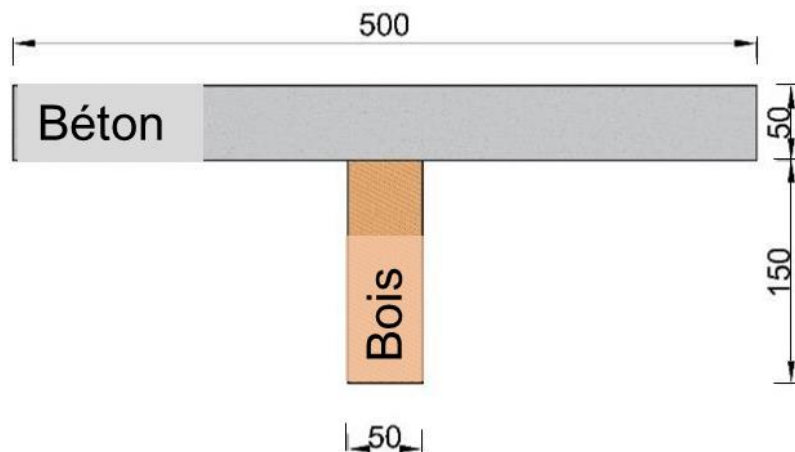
Section transversale de la poutre mixte bois-béton
